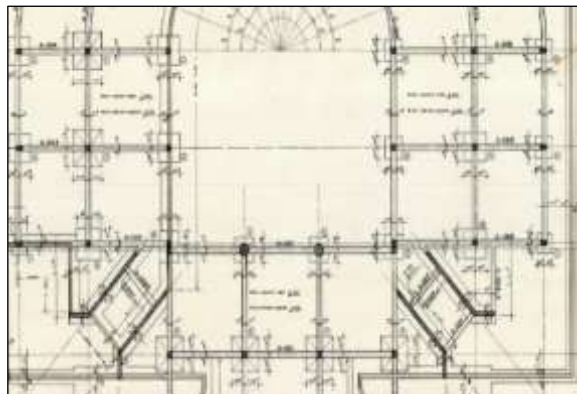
Fuente: autores, (2018). Cimentación del edificio según plano estructural, planos originales alcaldía por Ing. Carlos Navas Camargo.
